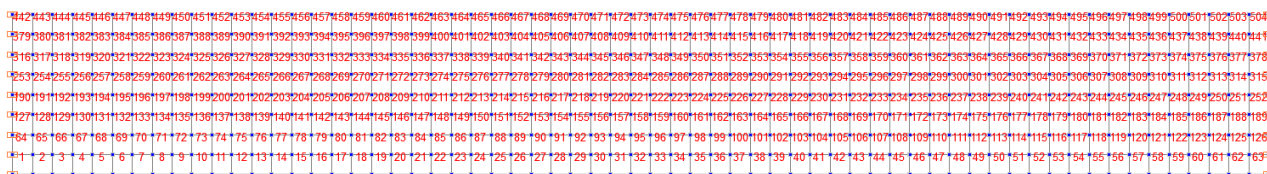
Расчётная схема плиты перекрытия в плоскости:
